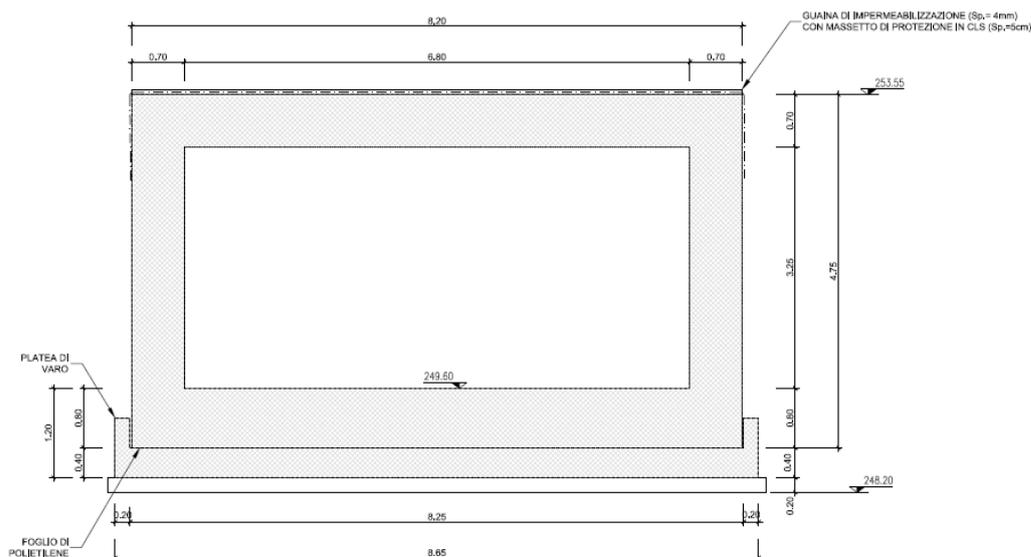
Sottopasso stazione di Ellera Sezione trasversale monolite
